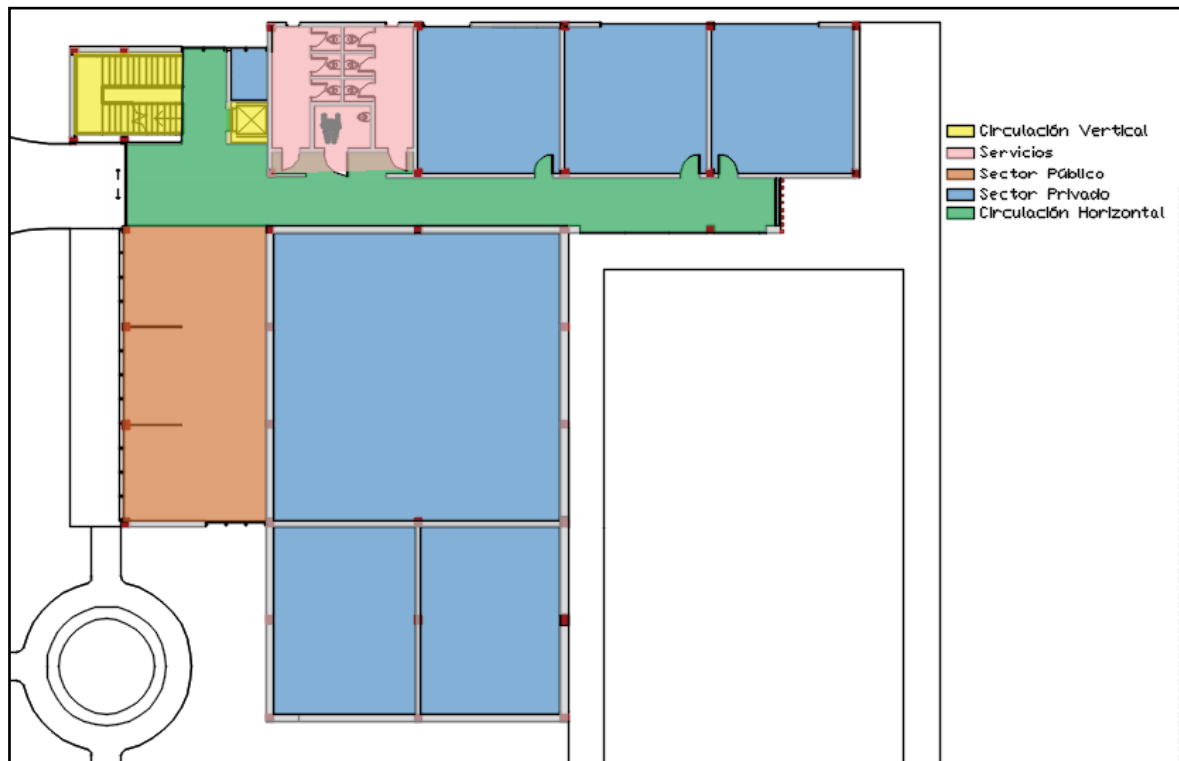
a: Distribución de espacios en Planta Baja
